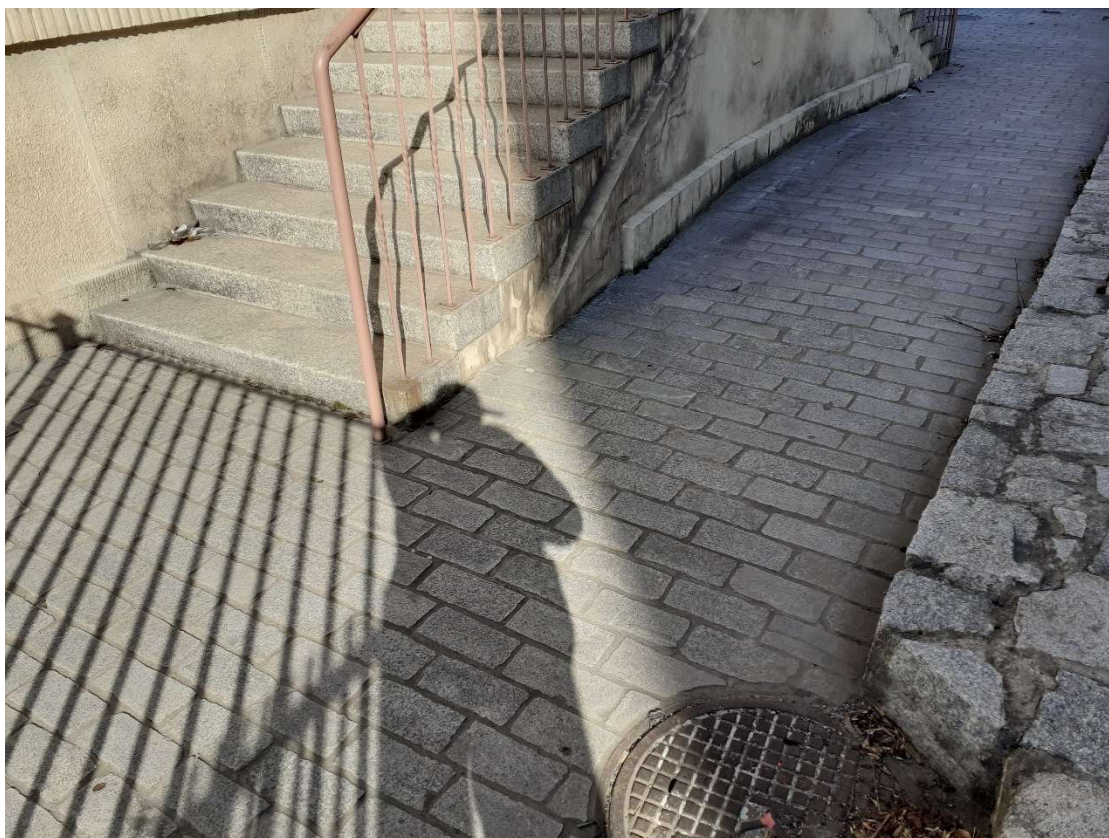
teren bezpośrednio przed budynkiem – brak odpowiedniego odwodnienia, przy oknach widoczne ślady po wodzie która zalewa wnętrze budynku, widoczne zastoiska wody, zdegradowane elementy nawierzchni, murki oporowe, murki terenowe do renowacji. zdegradowane elementy nawierzchni, murki oporowe, murki terenowe do renowacji.
